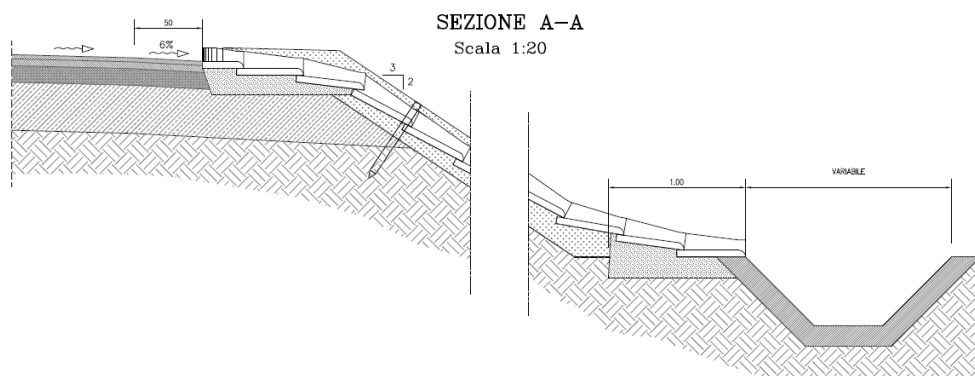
sistema di drenaggio – sezione in rilevato
